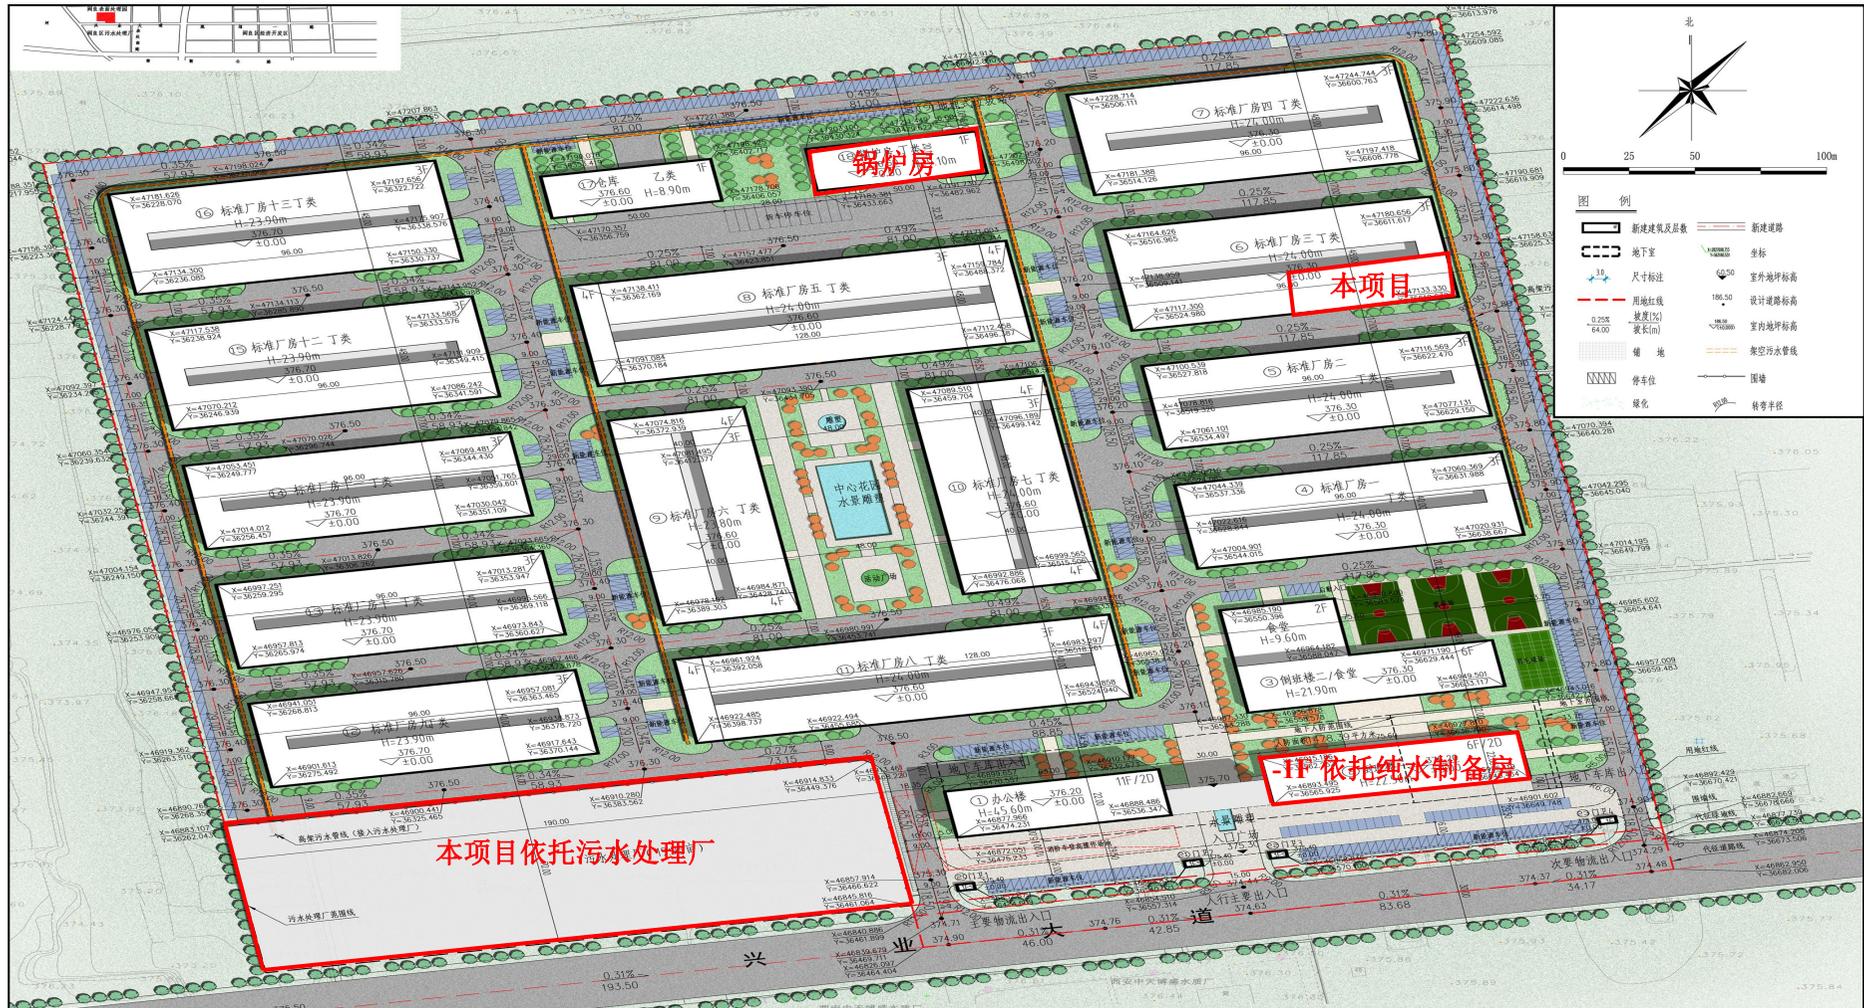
本项目所在西安航空基地表面处理中心总平面布置图
